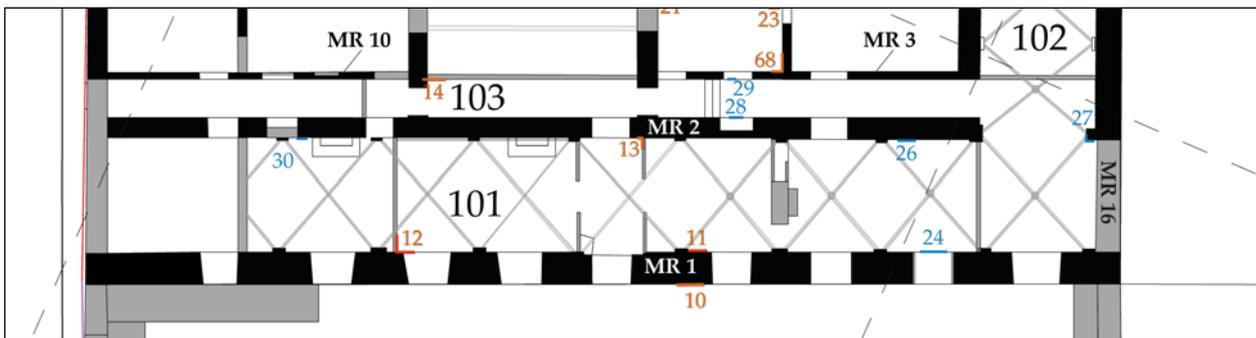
Plan de localisation des faits de l'espace 101 (DAO M. Panneau, S. Ranchin)
